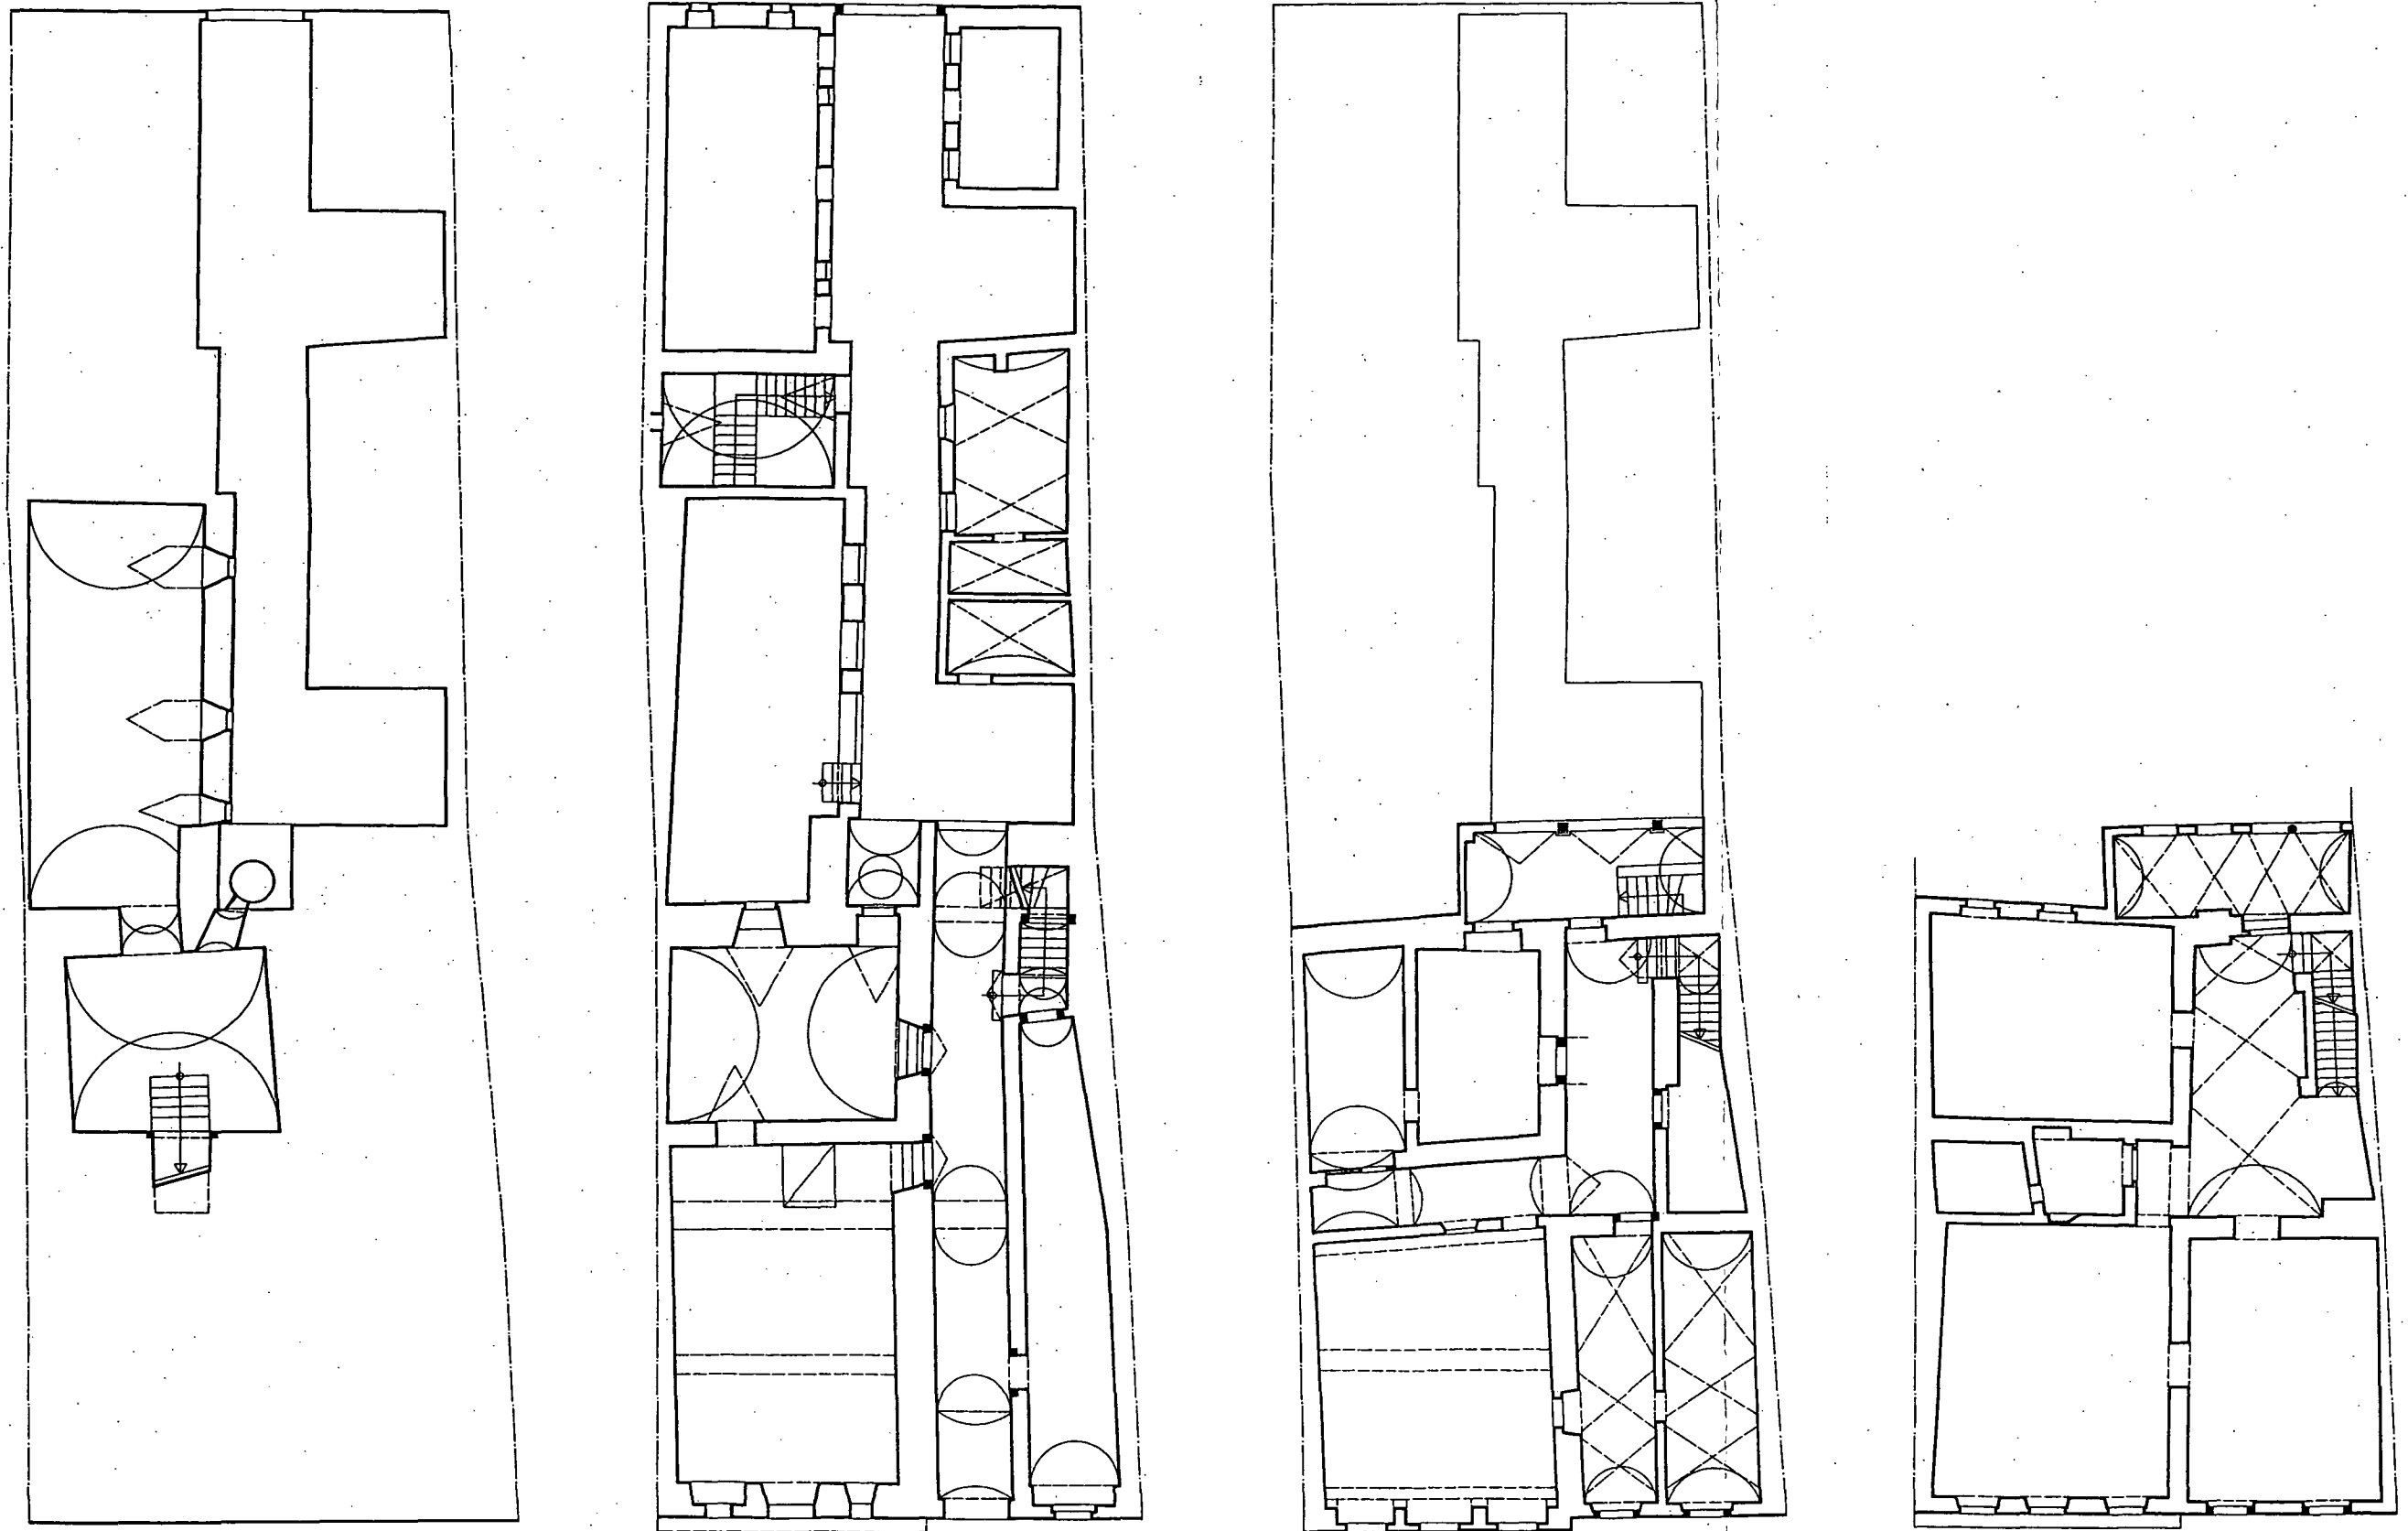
Stadtplatz 27 – Grundrisse Keller, Erdgeschoss, 1. und 2. Obergeschoss (1:200).
